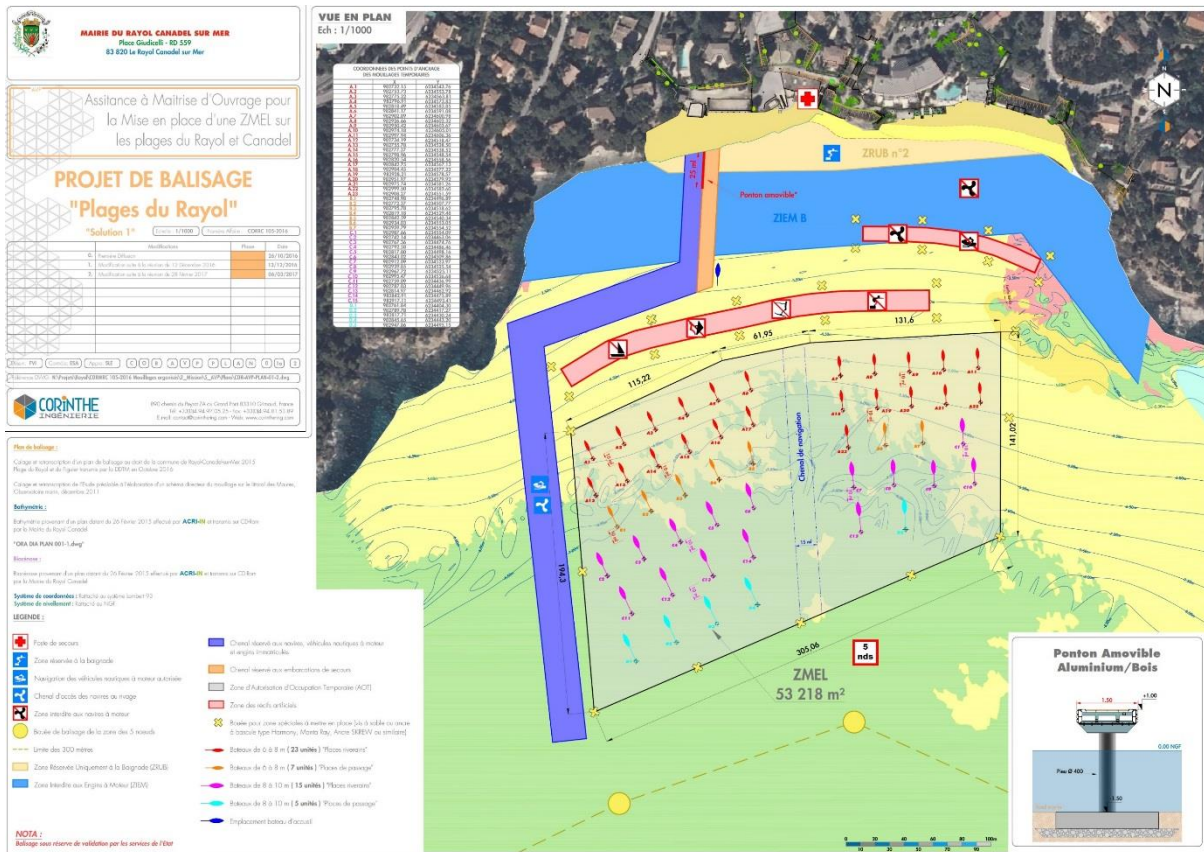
Vue en plan du projet de ZMEL sur le secteur du Rayol
